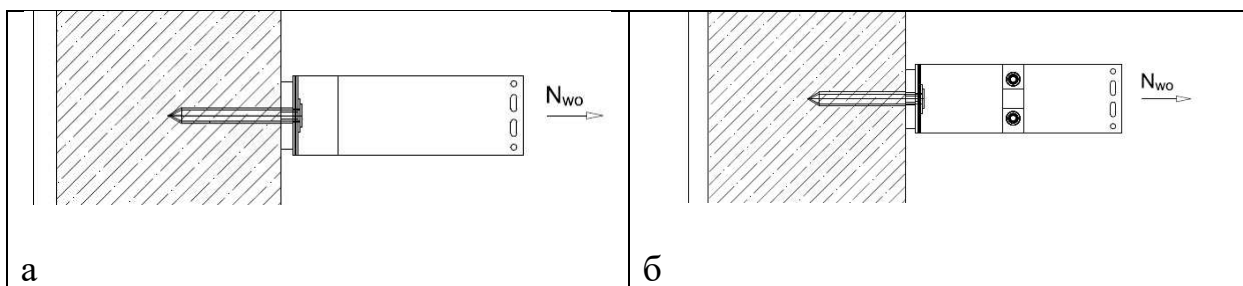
Расчетные схемы действия нагрузок на опорные кронштейны
